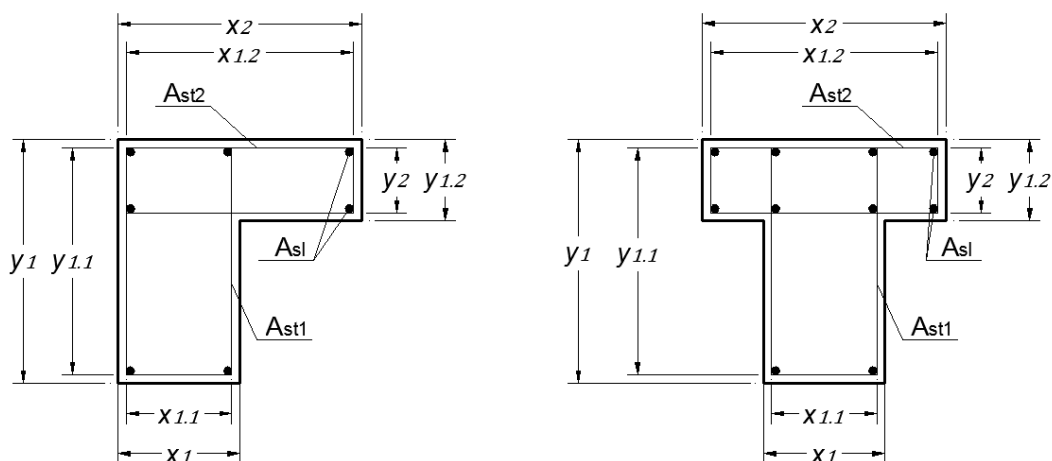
Exemplo de viga do tipo “L” e “T”
